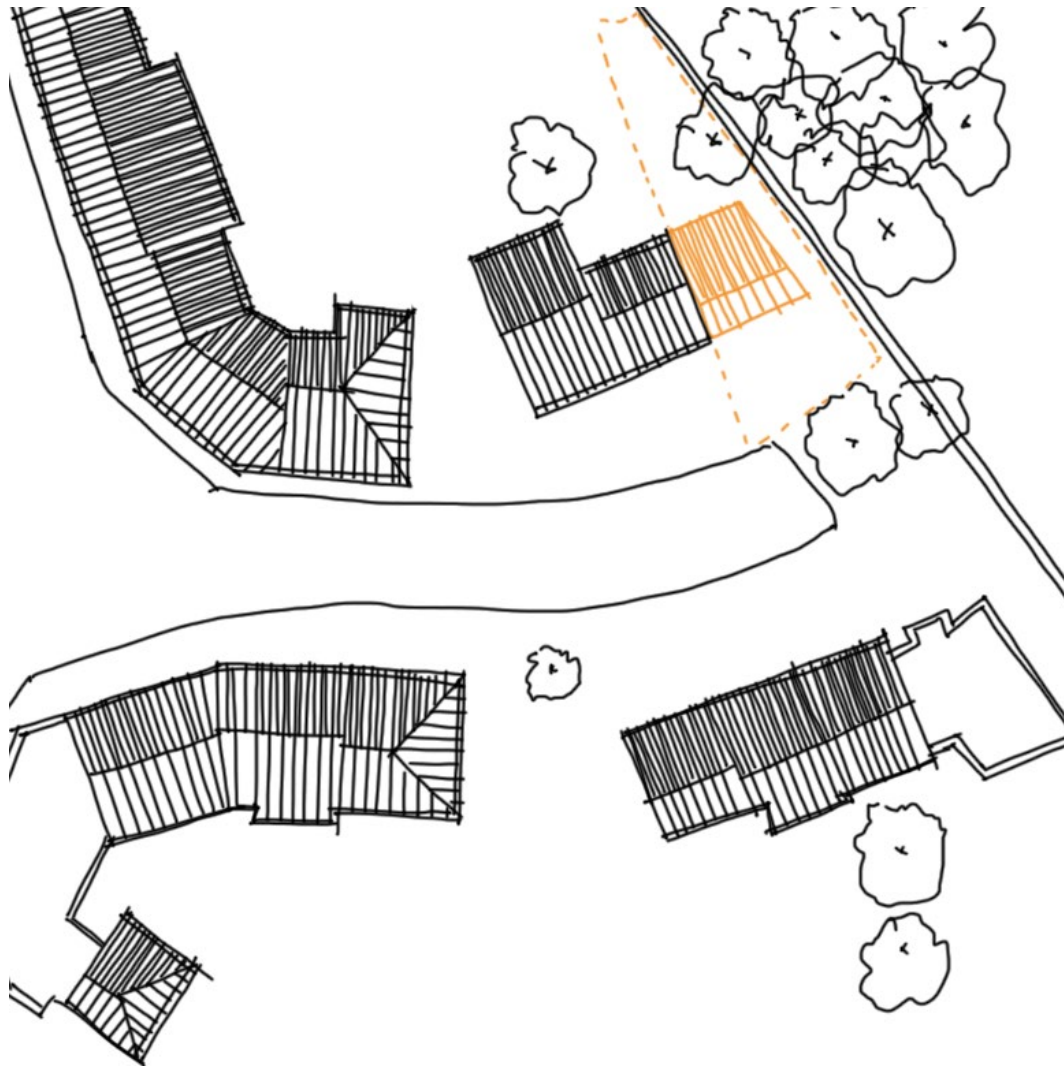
Plan d'implantation du projet VDN 037 (Léo Roussel)
